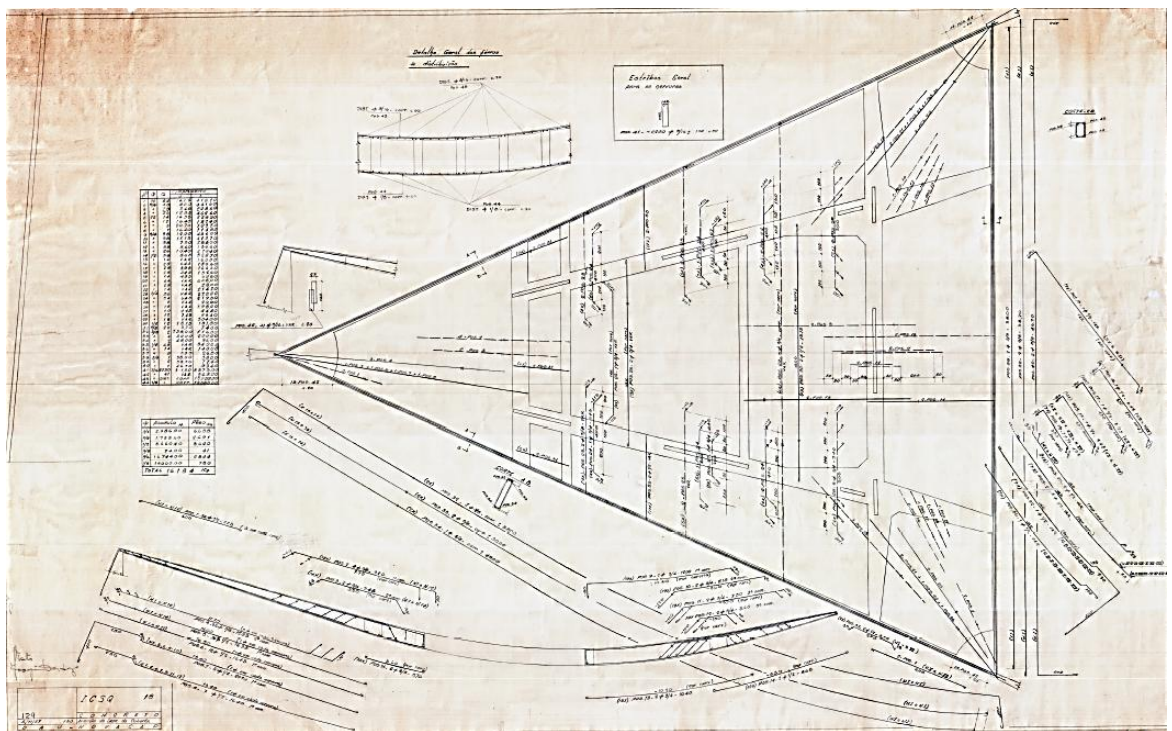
| Armação da laje de cobertura. 5.11.1957
